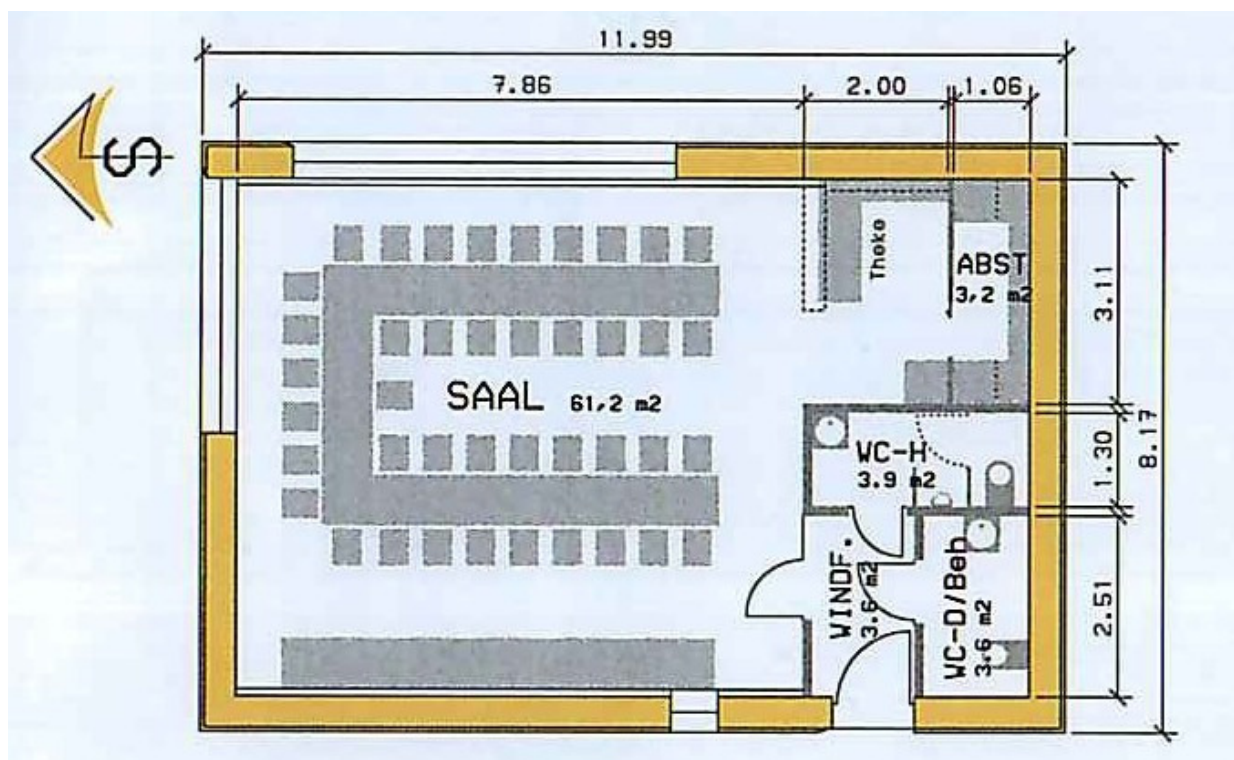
Grundriss des Dorfgemeinschaftshauses Uppershausen
